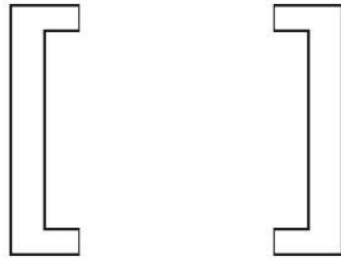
planimetria horizontal do envelope para o exemplar de São Paulo
